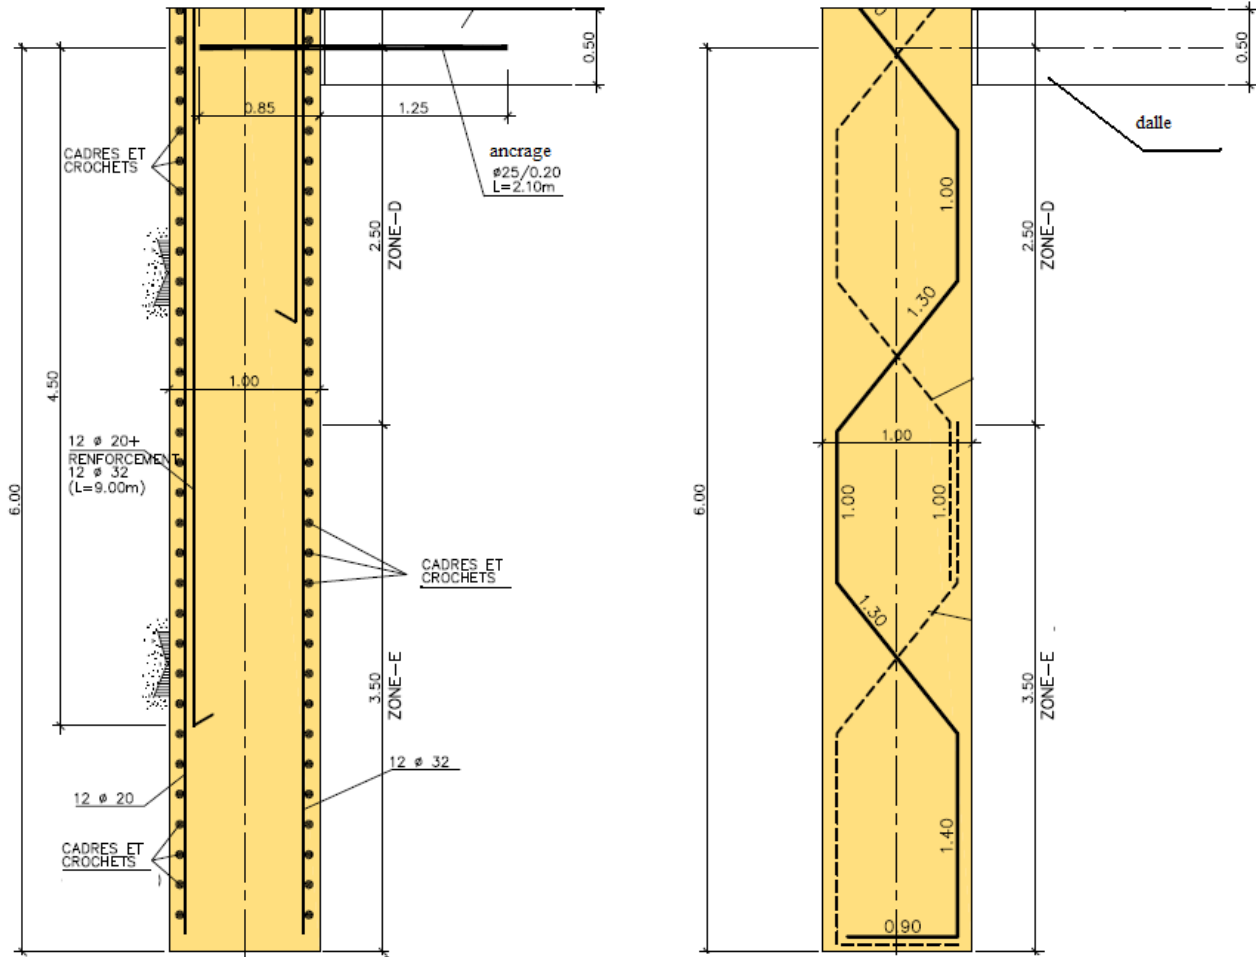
coupe ferrailage de la partie ancrée de la paroi latérale
